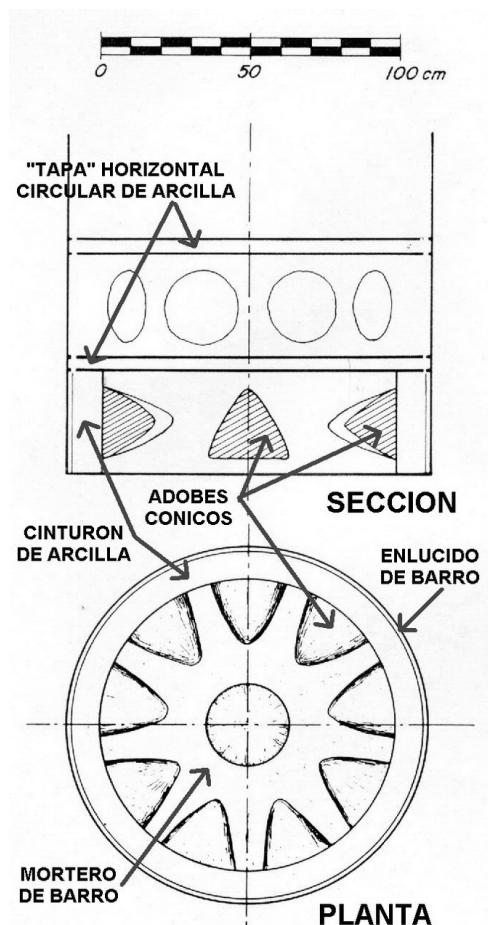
Columna construida con adobes cónicos. (Redibujado de Shimada, 1983).
